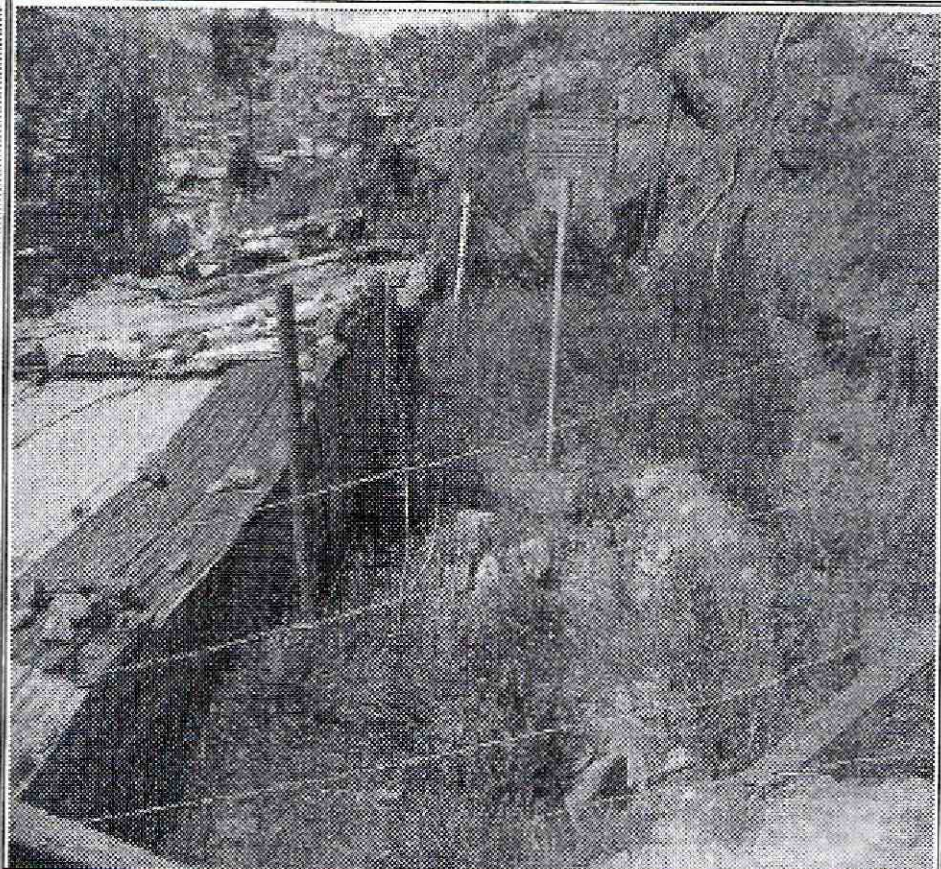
Talud de corte para el emplazamiento de la vivienda
